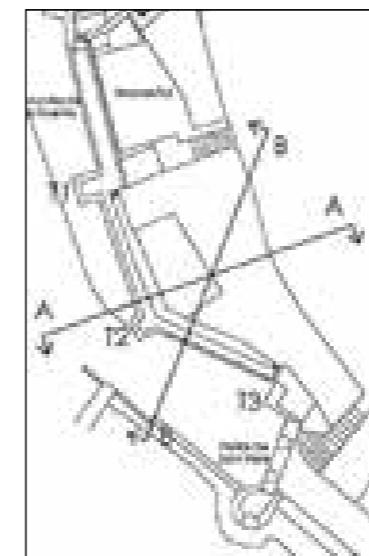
Esquema en planta de la muralla de la Fuente marcando las secciones y torres
